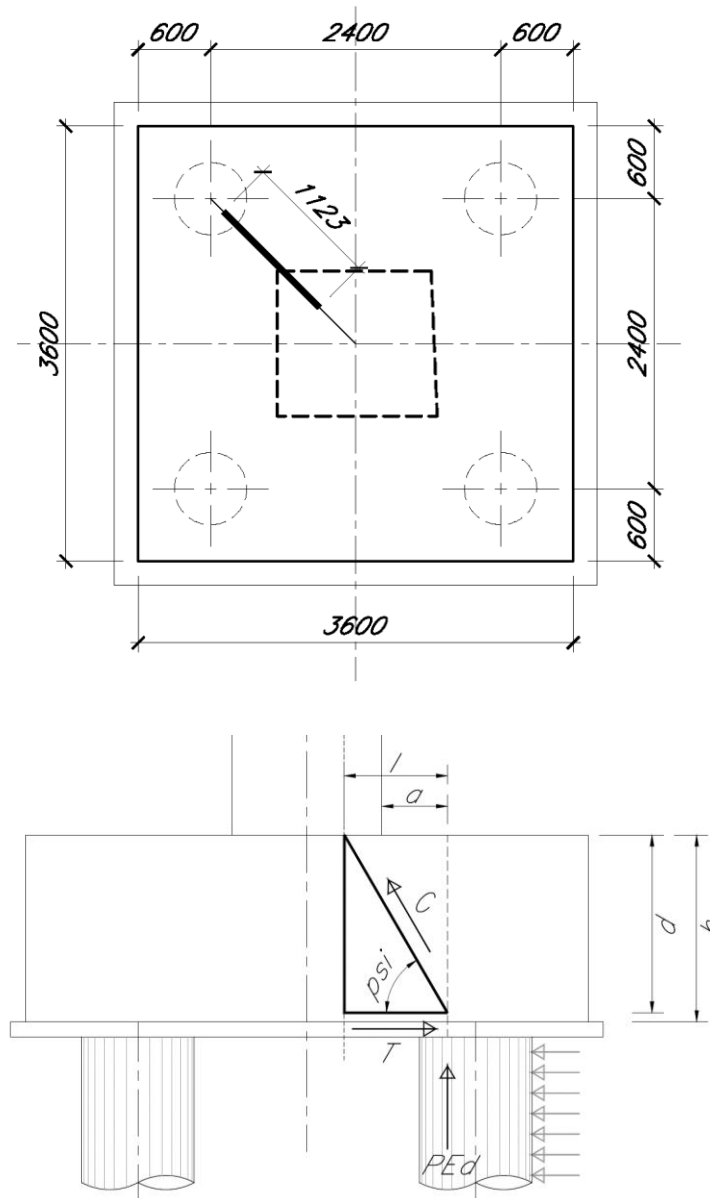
Tirante puntone - Biella compressa di calcestruzzo C e tirante di armatura T
